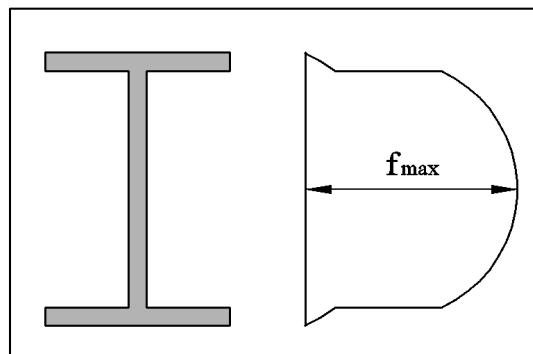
Distribución Esfuerzo Cortante en Viga.
